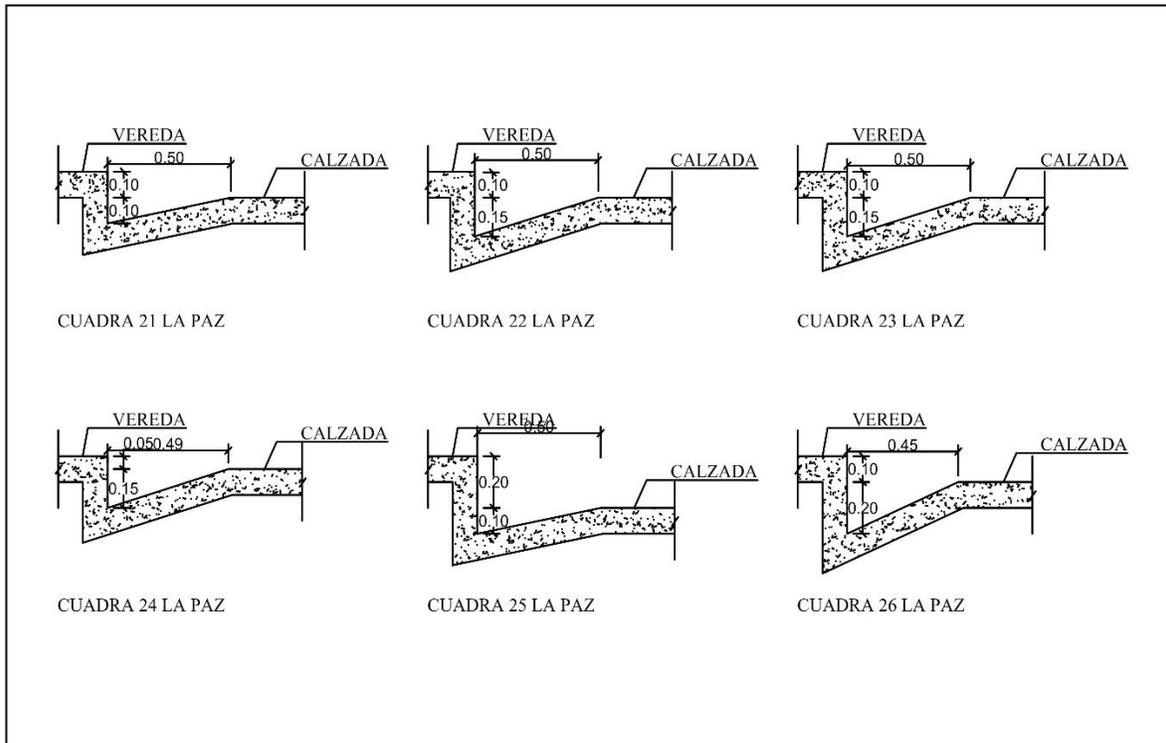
Tipo de secciones de cunetas de las calles de la Av. La Paz.
